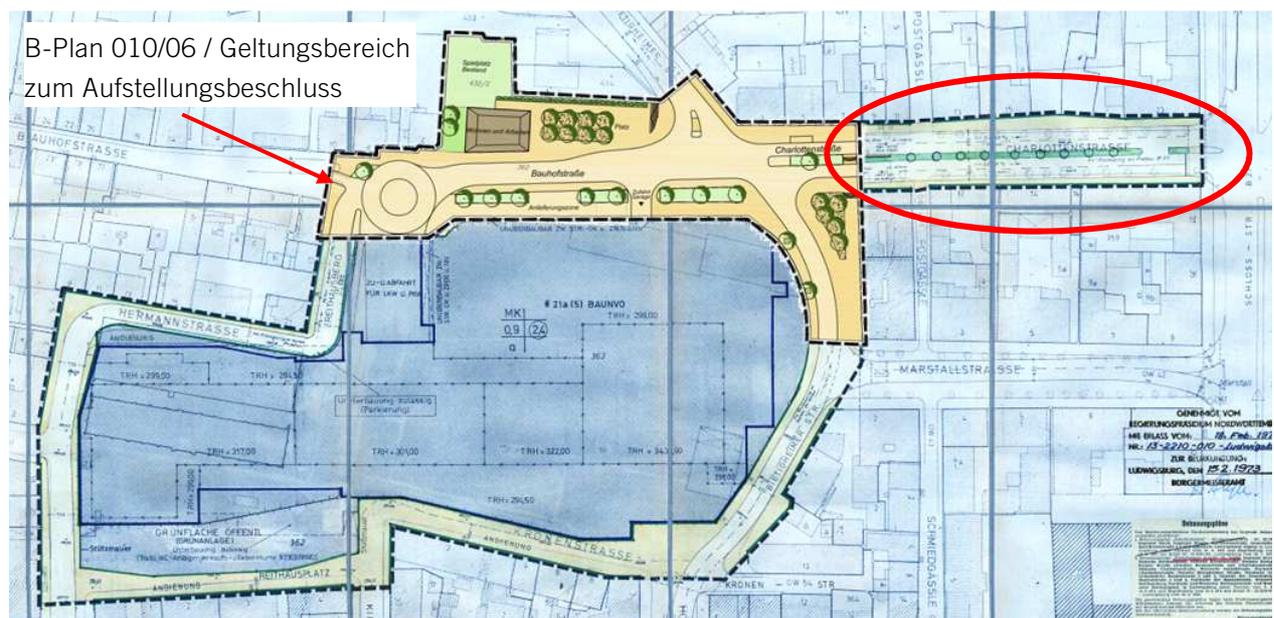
Bebauungsplan 010/02 vom 11.03.1972, überlagert mit geplantem Geltungsbereich B-Plan 010/06
